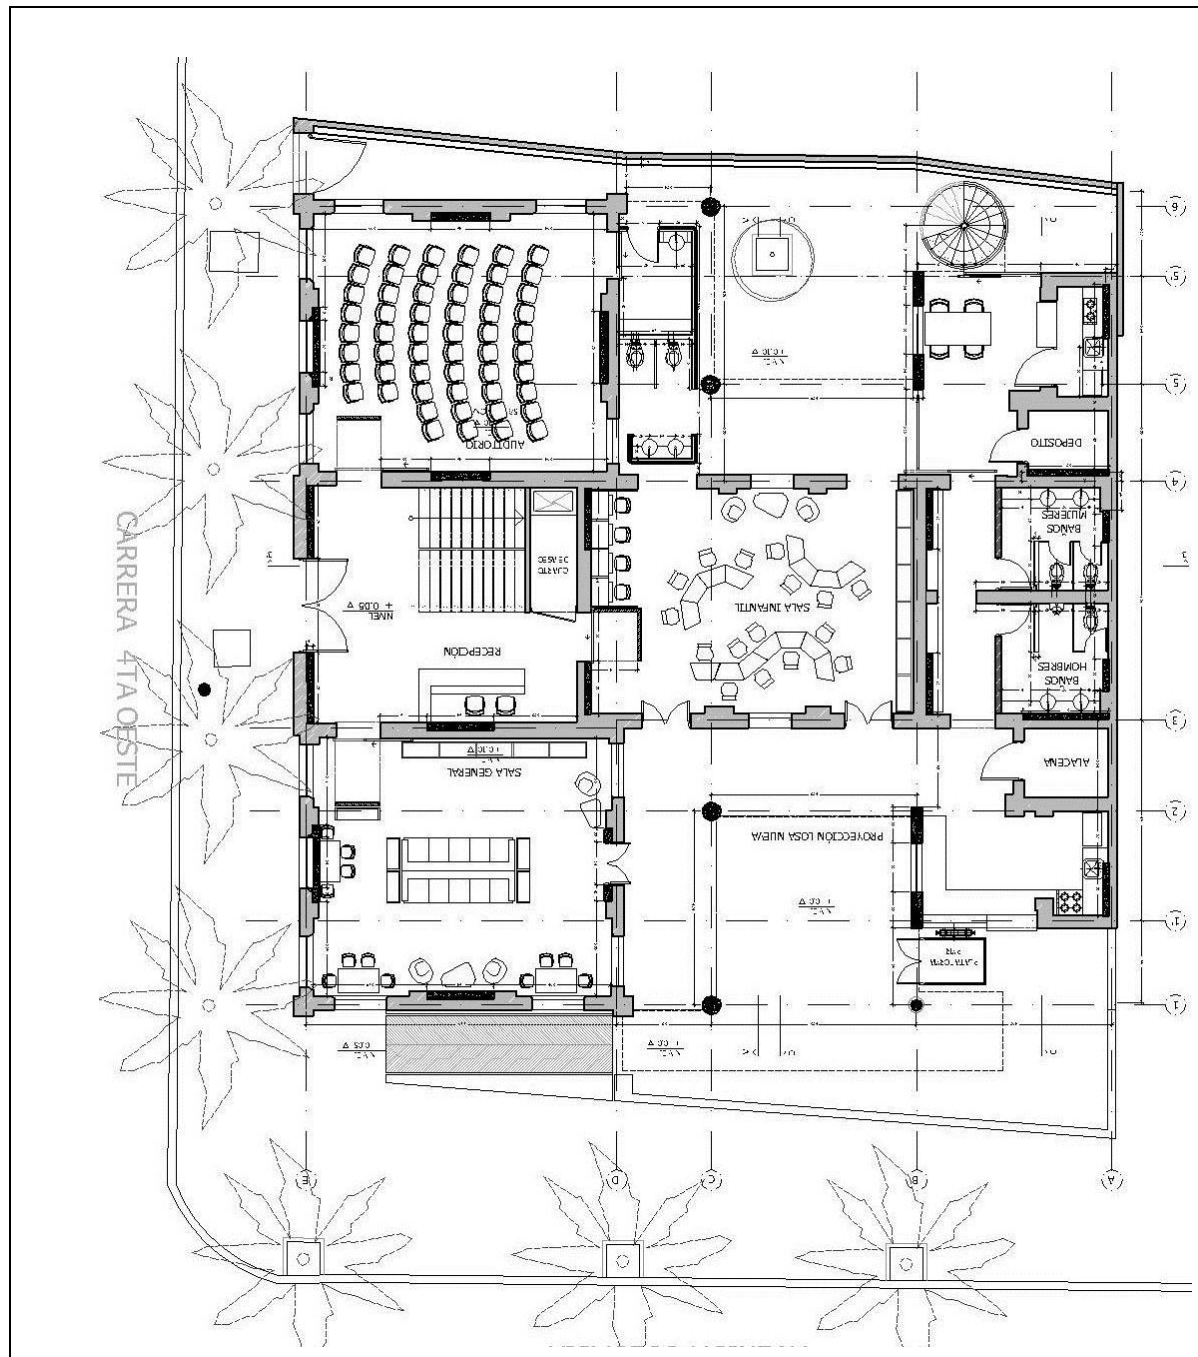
Edificio Biblioteca del Centenario. Planta arquitectónica – Nivel 2.
